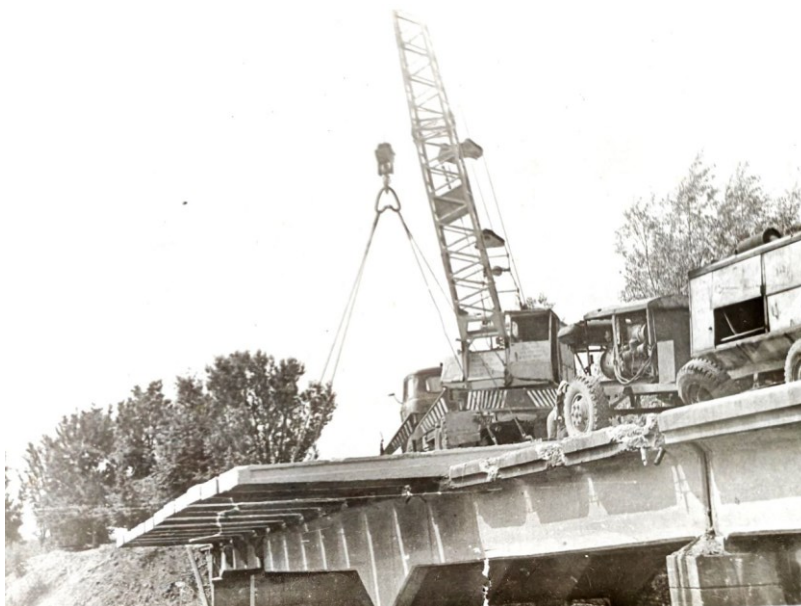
Монтаж збірних залізобетонних ребристих накладних плит
